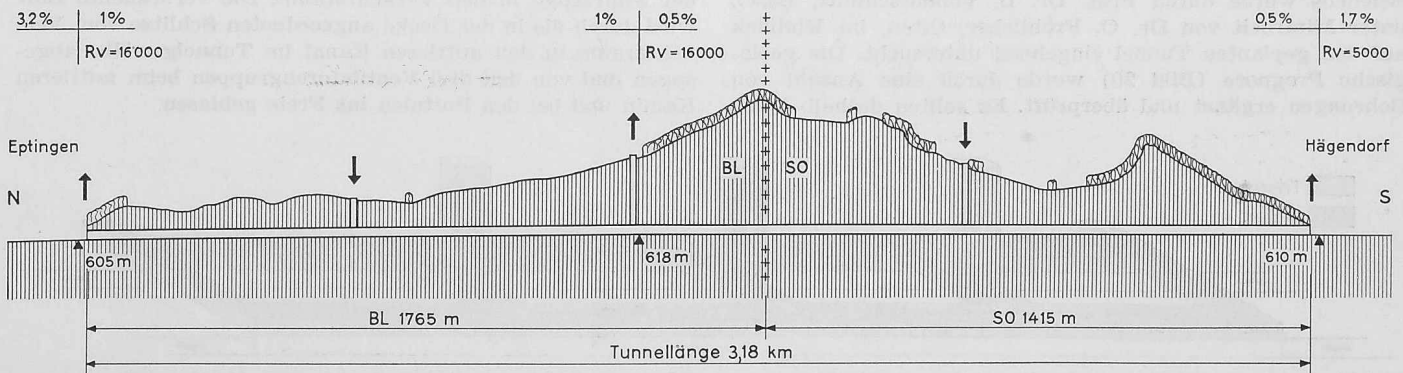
Belchentunnel, Längenprofil 1:20 000 mit den drei Lüftungsschächten, Axidistanz der Tunnelröhren 40,0 m
